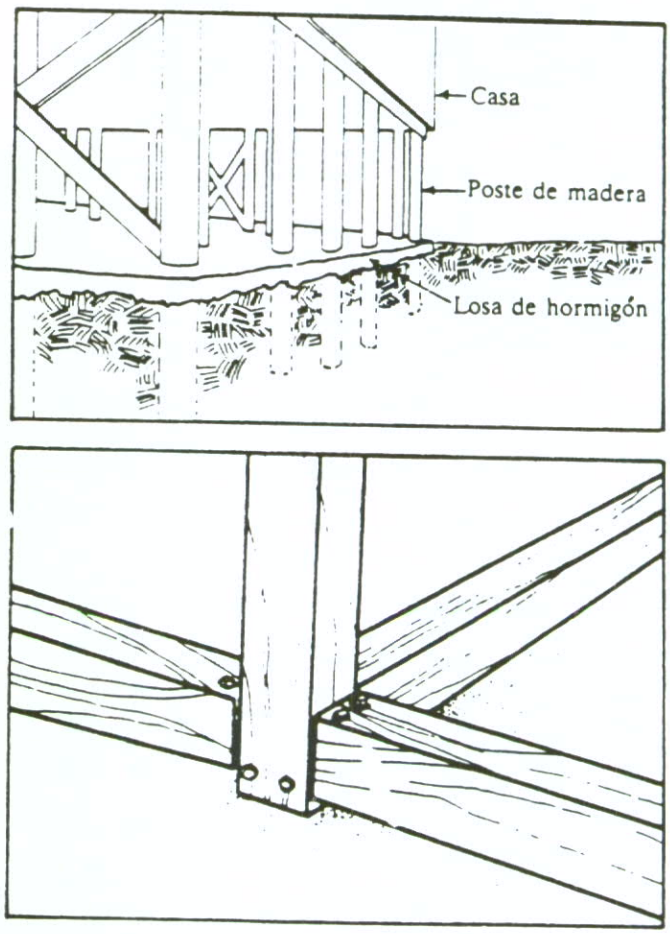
Instalación de refuerzos bajo el nivel del terreno
